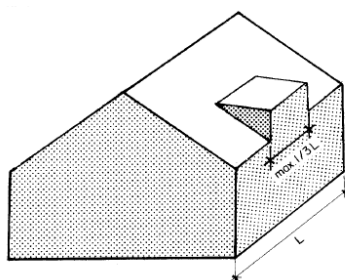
schematische Darstellung Dachaufbauten gemäss altPBG (1/3 der Fassadenlänge)
